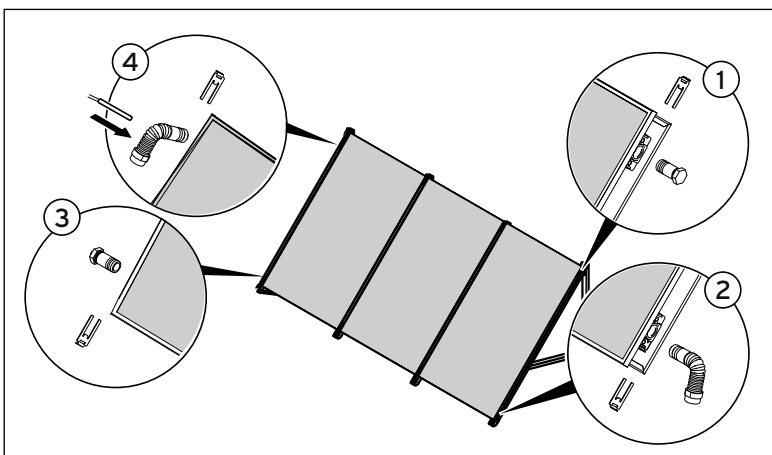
Montaggio contrapposto dei collegamenti idraulici (1-3 collettori piani VFK 135/2 VD)
